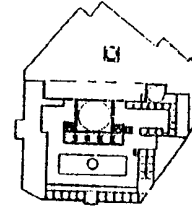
مسقط أفقى لزاوية الدمرداش
